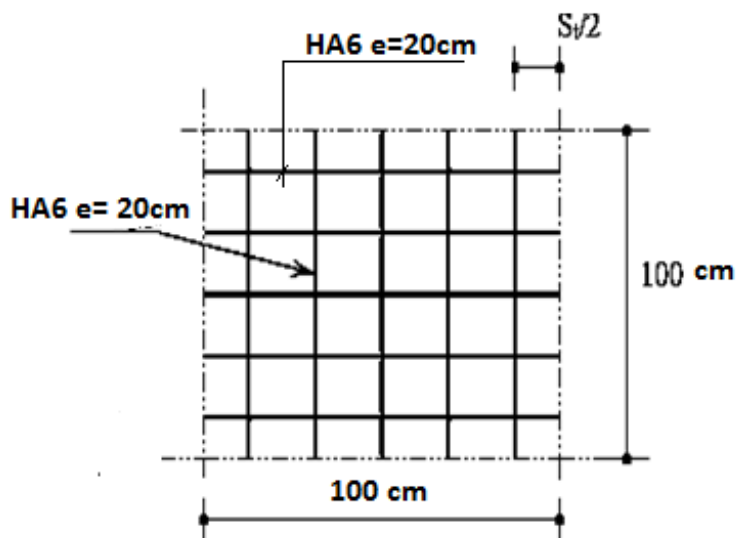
Disposition constructive des armatures de la dalle de compression.
